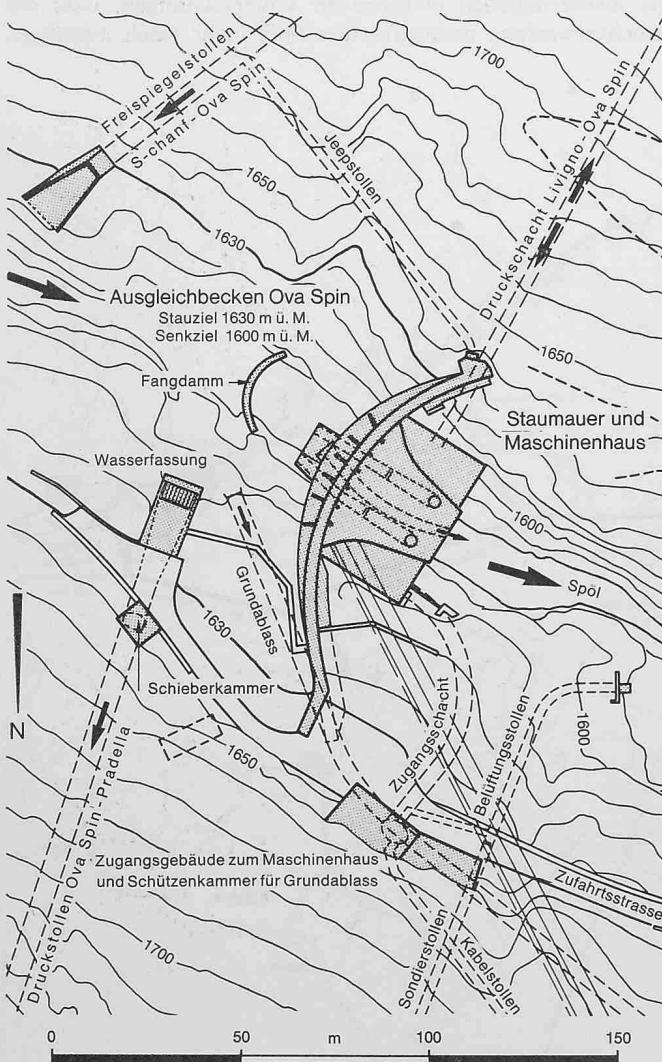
Lageplan von Staumauer und Maschinenhaus Ova Spin samt den ankommenden und wegführenden Triebwasserstollen.
